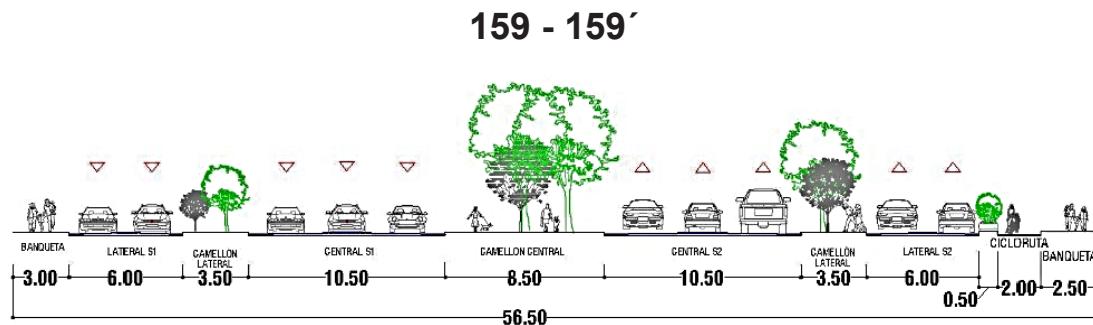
Estructura Vial y Conectividad. Fuente: Elaboración propia.
